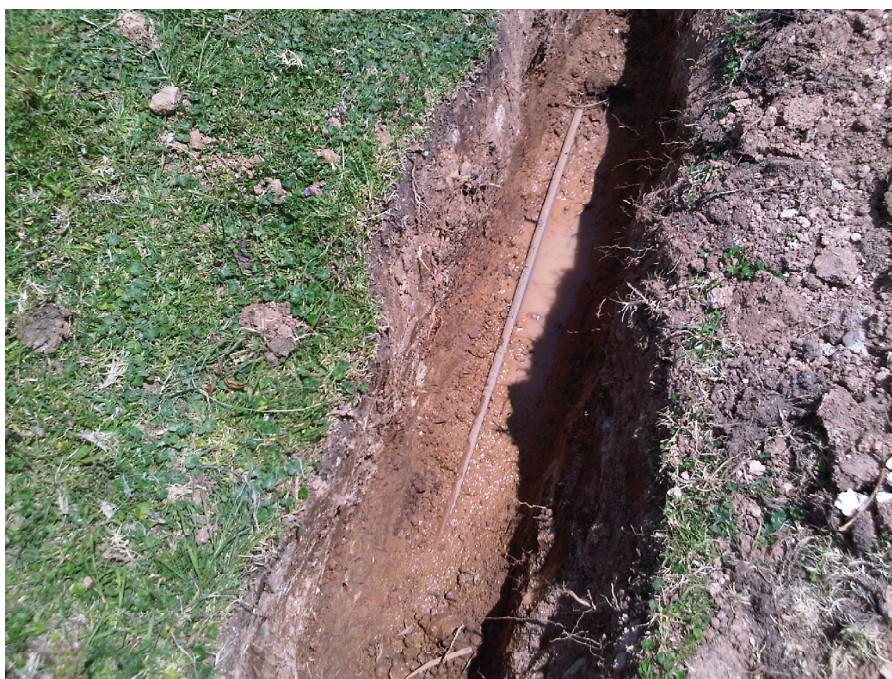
Reserva de Hormigón Ciclópeo
